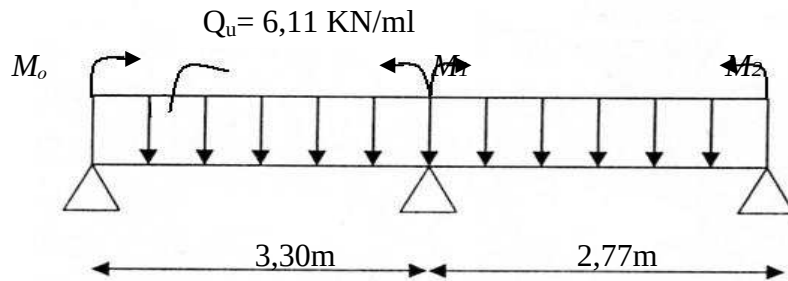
schéma statique de la poutrelle type 5 à l'ELU
